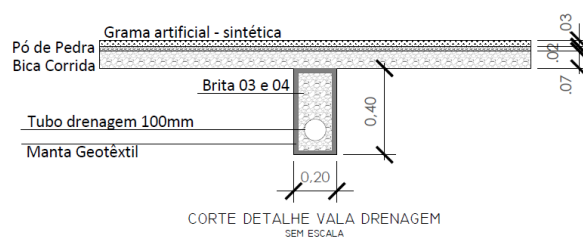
Detalhe de instalação Drenagem (Fonte: Autora/2021)
